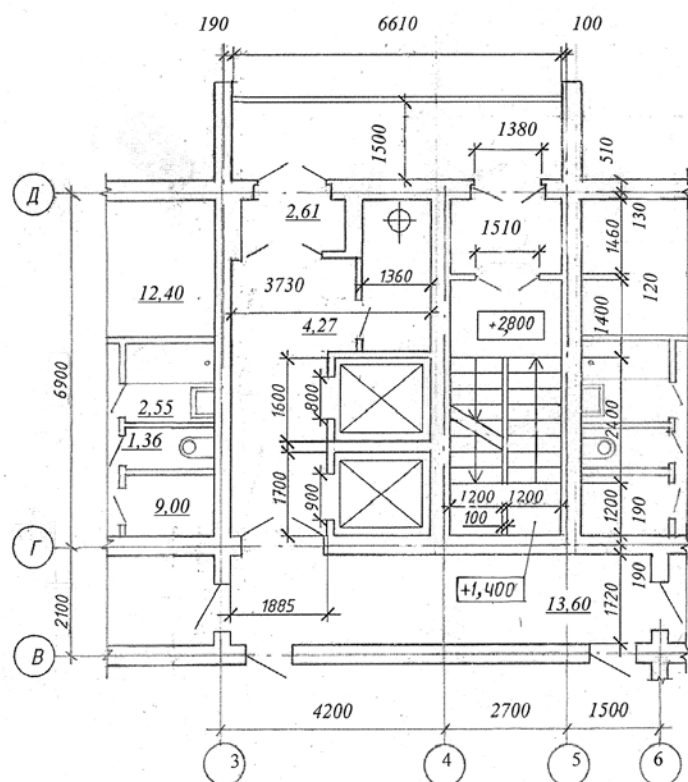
Пример выполнения фрагмента плана типового этажа жилого кирпичного дома с незадымляемой лестничной клеткой тип Н1
